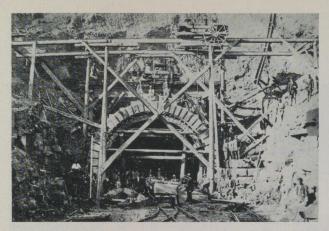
Bau des Eingangs zum Forsttunnel bei Althengstett; Gerüst mit 2 fahrbaren Winden zum Hochziehen der Quadersteine. Foto Ende 1869 oder Anfang 1870 (Fotosammlung Schüz Nr. 22).
